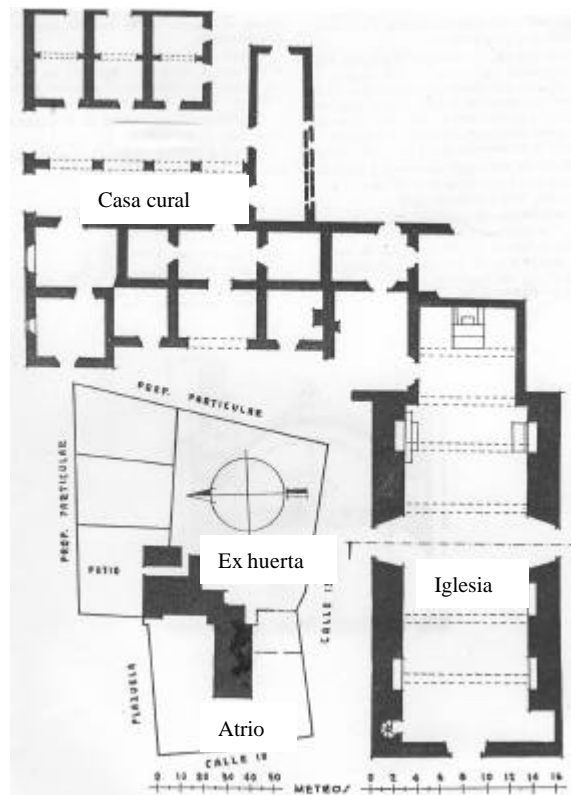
Planta del Convento de Tixcacalcupul. Vicaría fundada en 1645.
